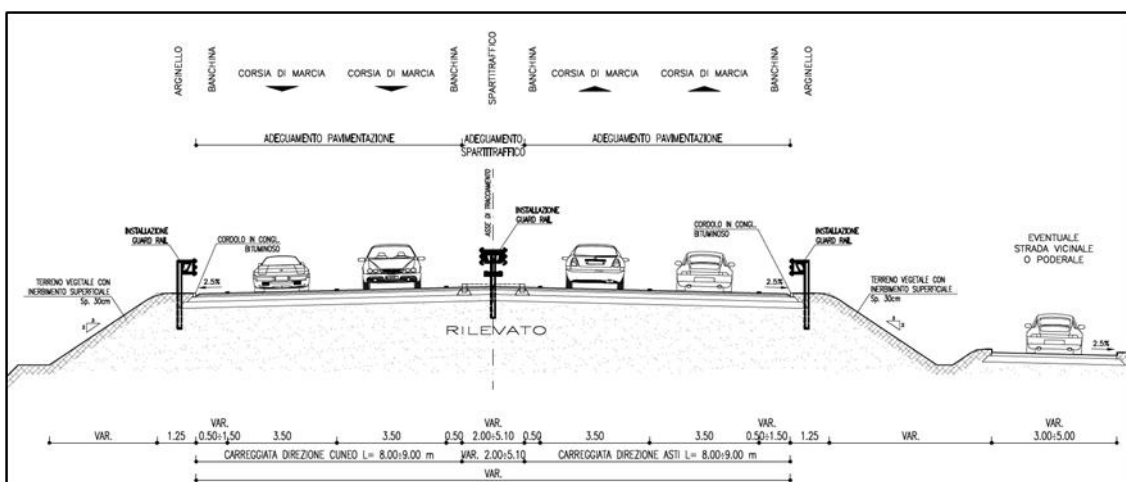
Sezione tipo asse stradale lungo asse principale
